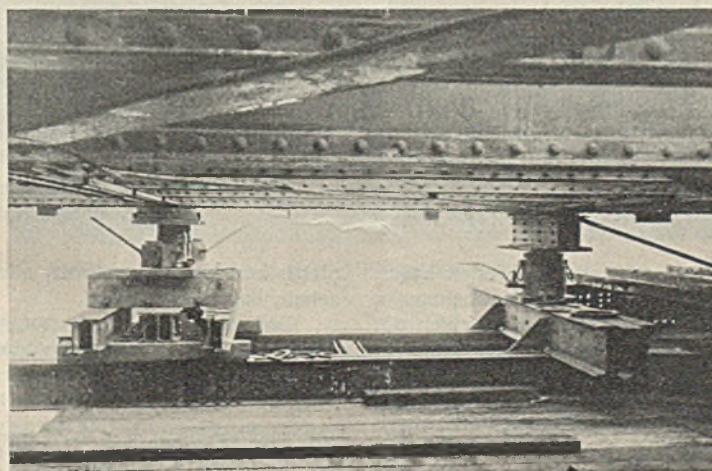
Hauptjoche für die Brückendemontage mit 2 Wasserdruckpressen von je 300 t Tragkraft.
